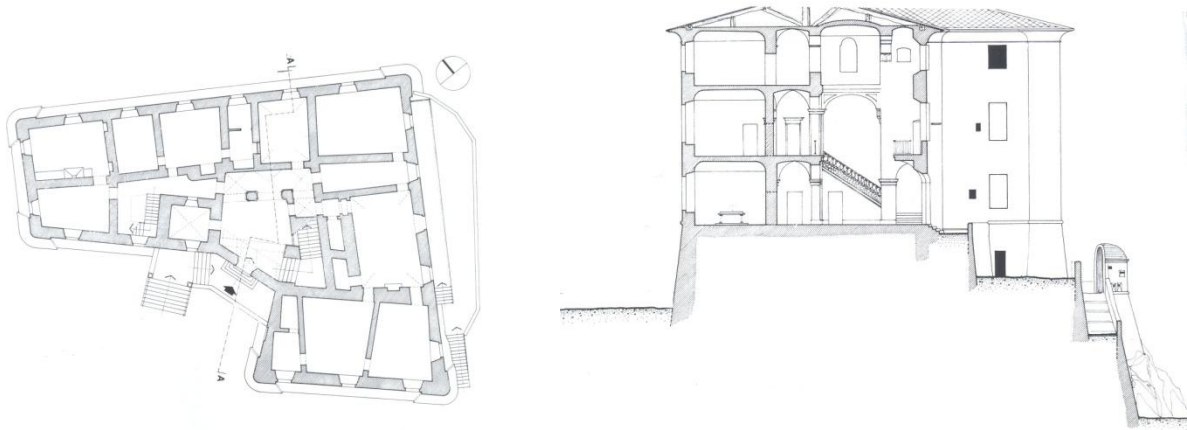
70 Castello dei Del Carretto, planimetria piano terra e sezione in scala 1:200.
